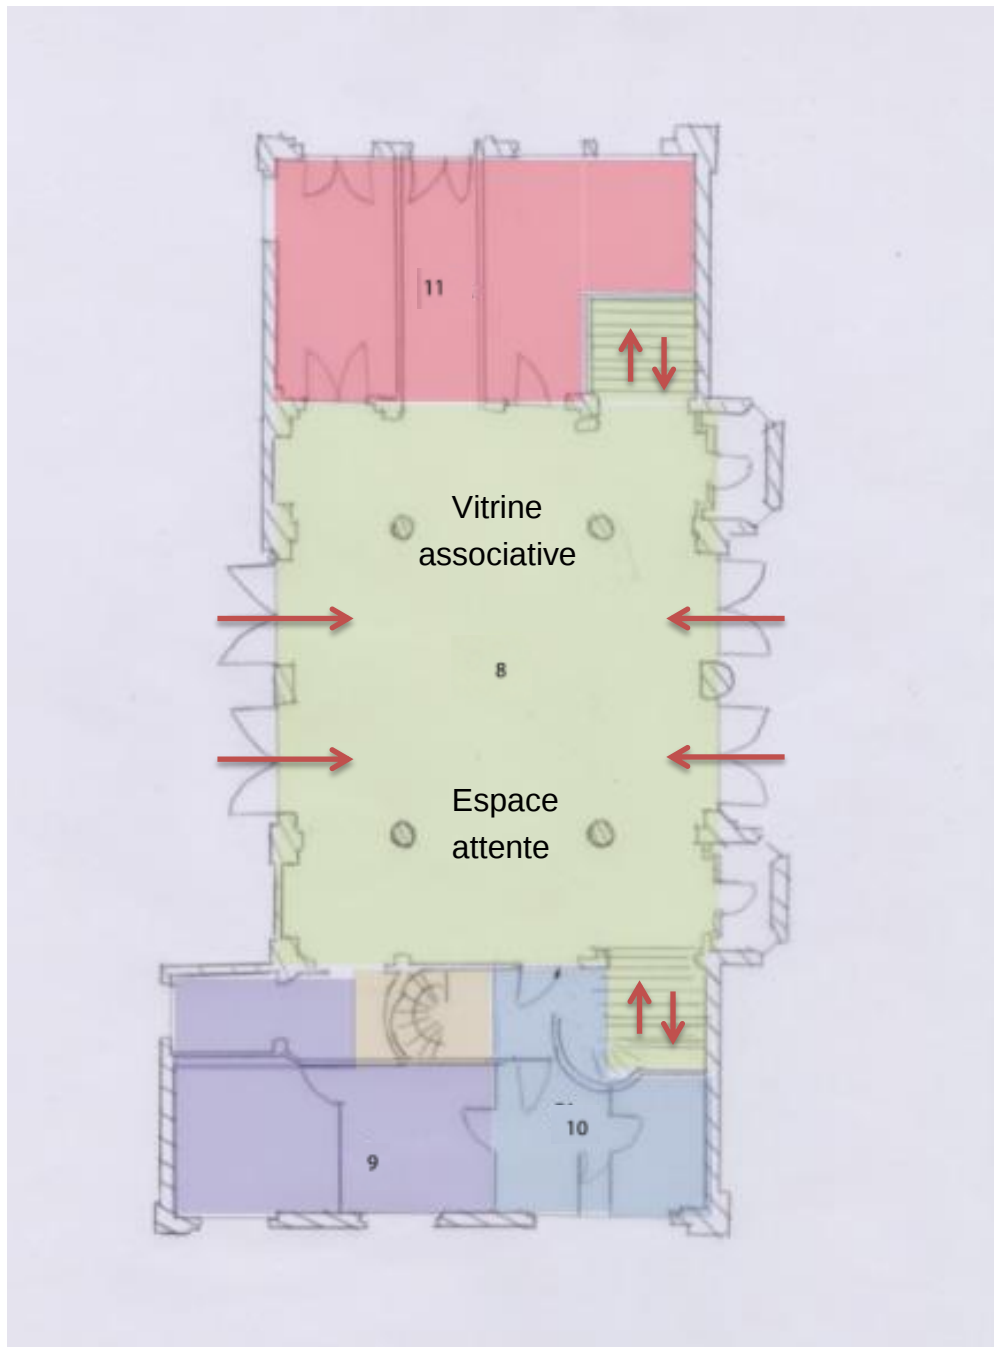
Proposition du nouveau plan du rez-de-chaussée– Réalisation Jade DOUGERE/ Adobe Illustrator
